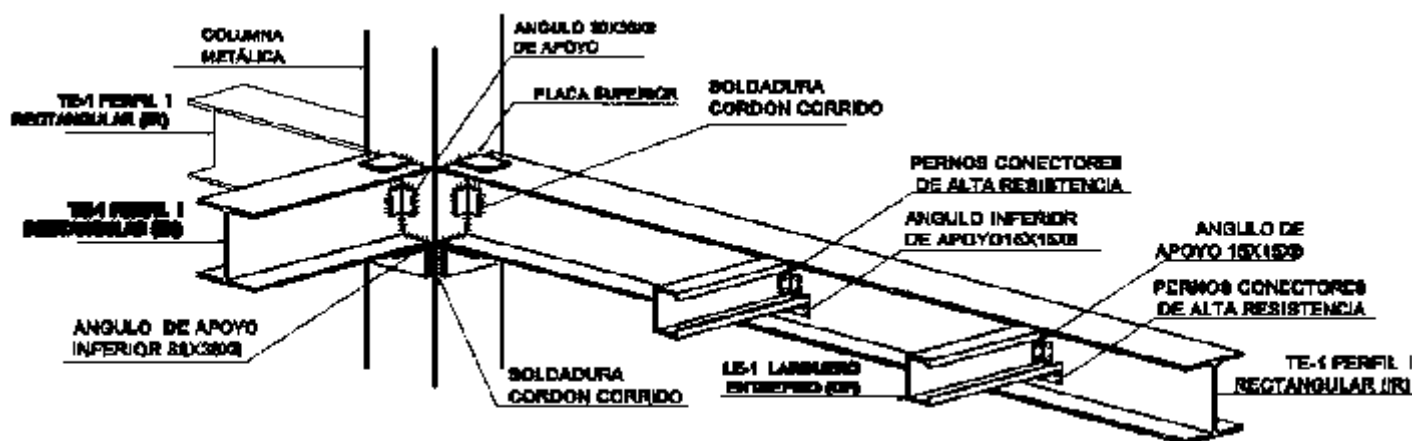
Detalle constructivo de unión de columna y vigas I. Elaboración propia AHMZ
